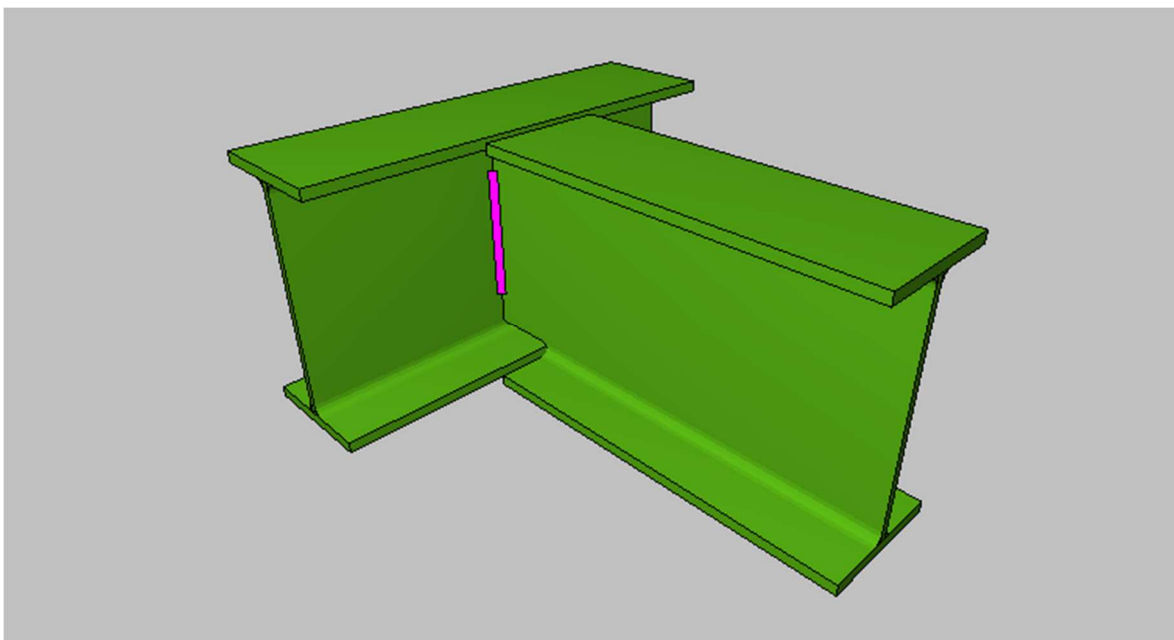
Unión tipo 4 soporte superior. Viga-viga
